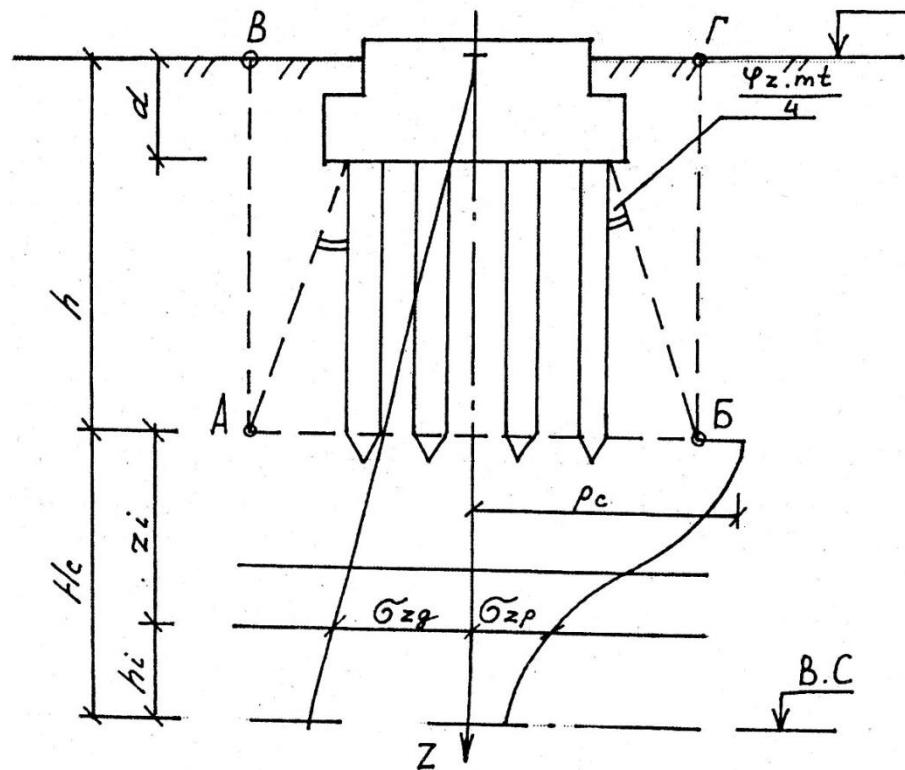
Схема к расчету осадки свайного фундамента как условного фундамента
